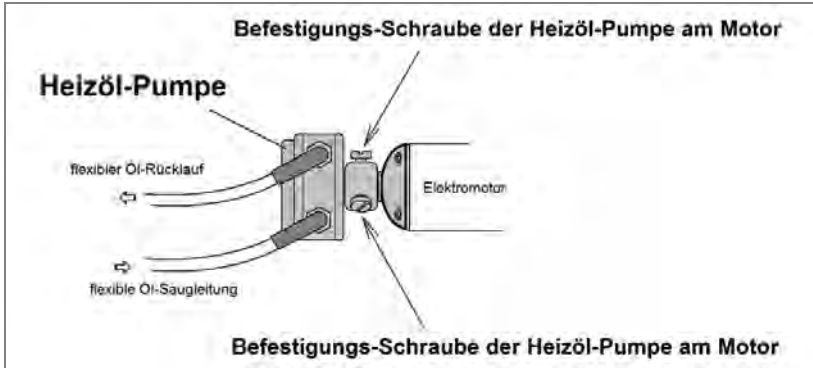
Die meisten Ölpumpen sind am Antriebsmotor nur mittels dreier Schrauben befestigt.
